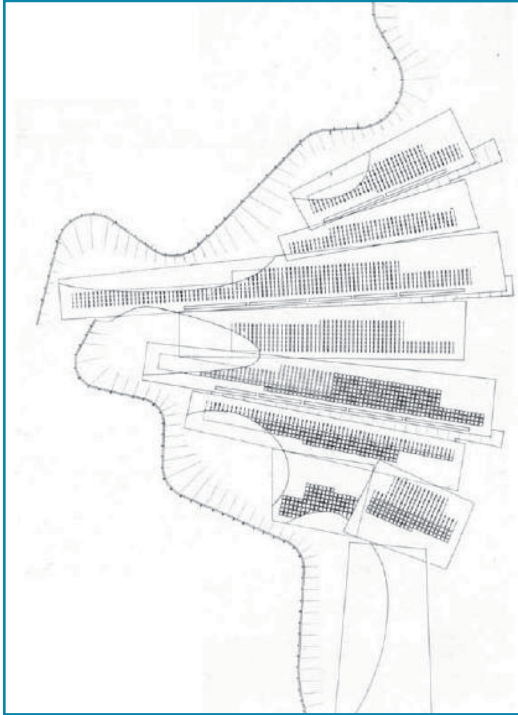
Cubiertas. Zona de entrenamiento encajada en la tierra.
